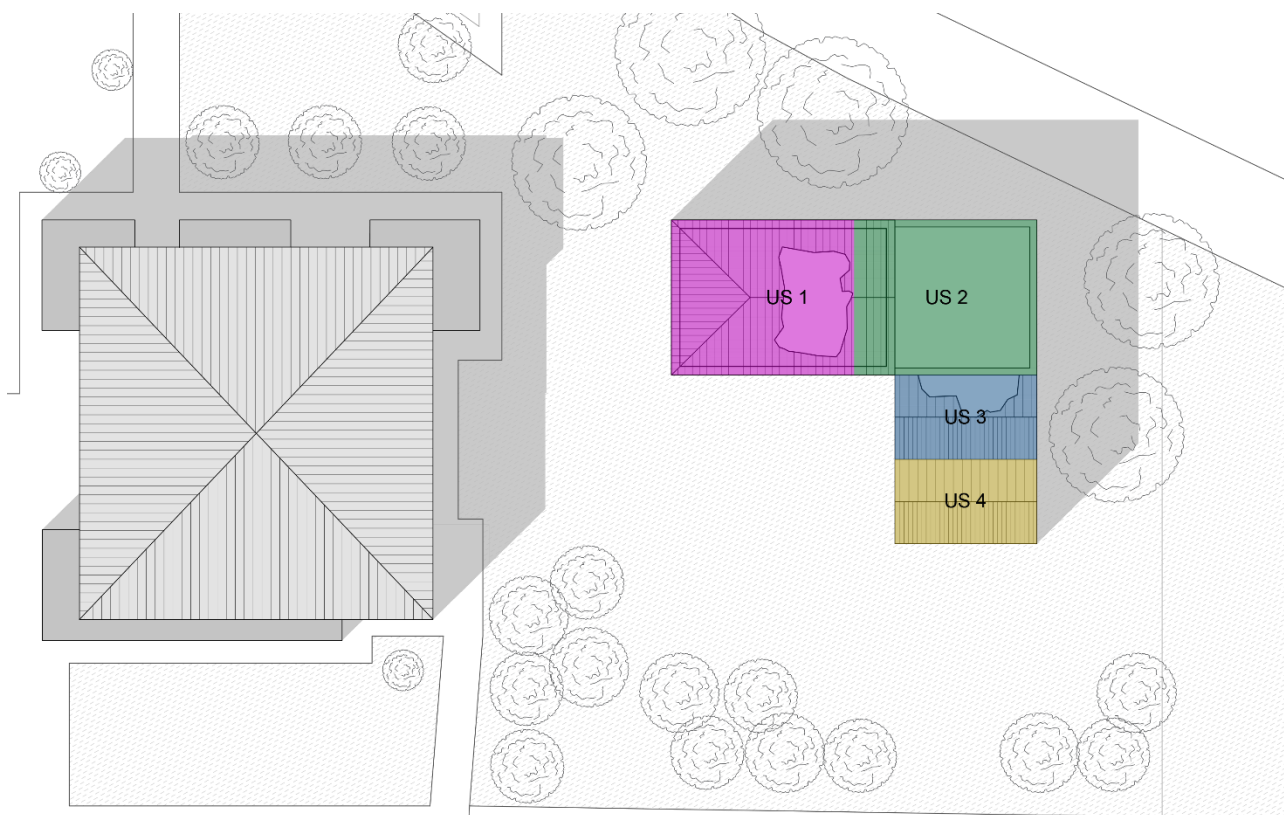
Planimetria allo stato di fatto_ Unità Strutturali
